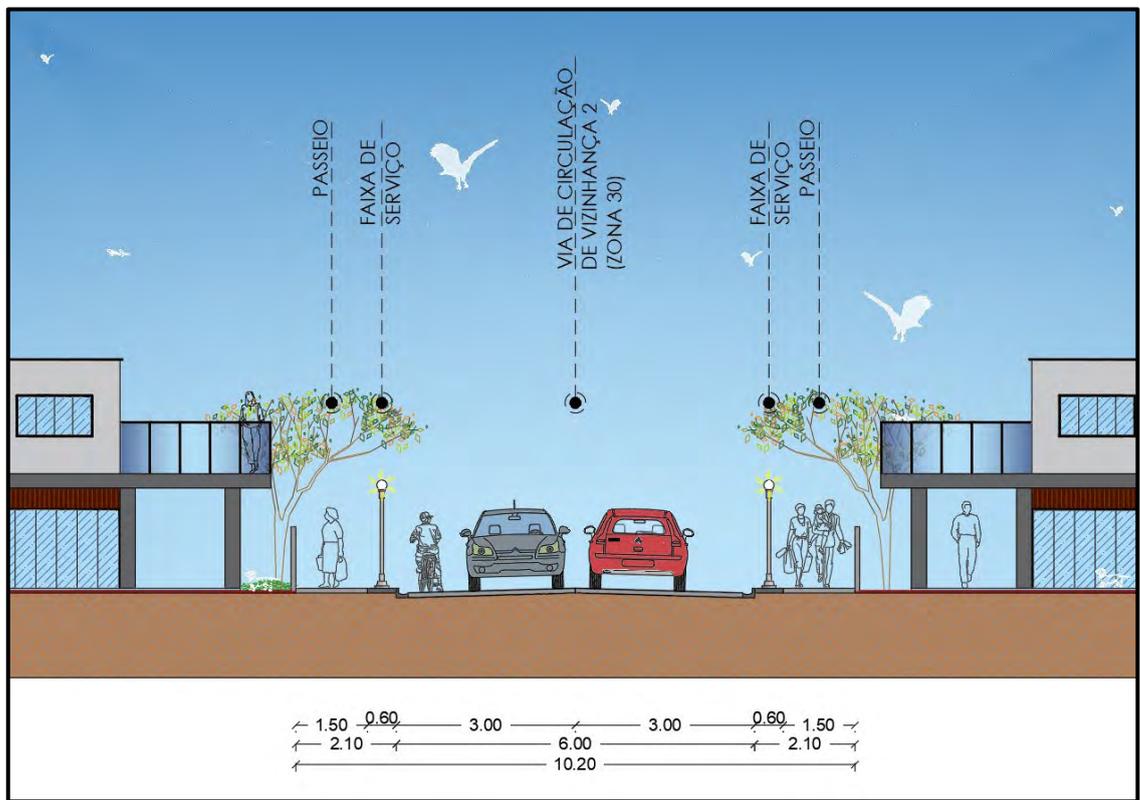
Perfil 03 - Via de Circulação de Vizinhança 2 – Zona 30 (Área Residencial)
